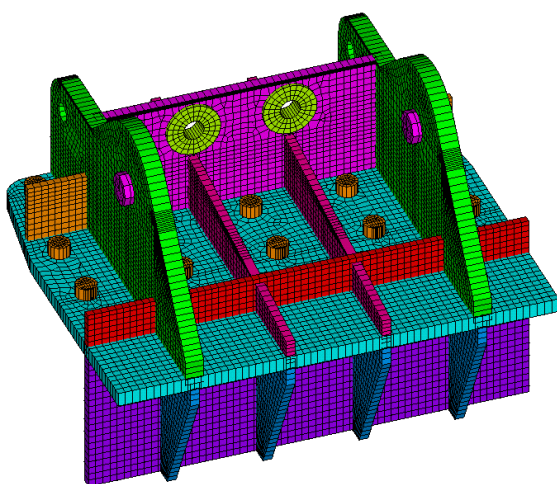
MEF. Encuentro de puntal inclinado a pila de hormigón.
